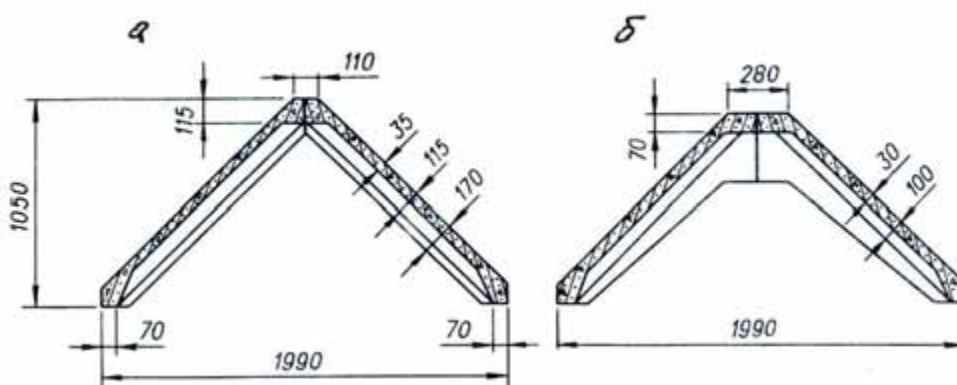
Попередньо напружені залізобетонні призматичні складки прольотом 18 м:
